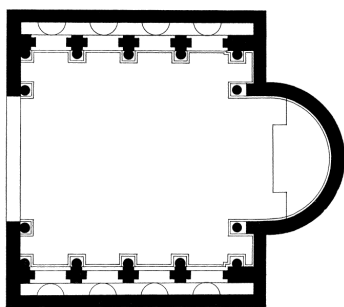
Planta del estado original del ninfeo de la villa de Horacio.²⁰⁶
